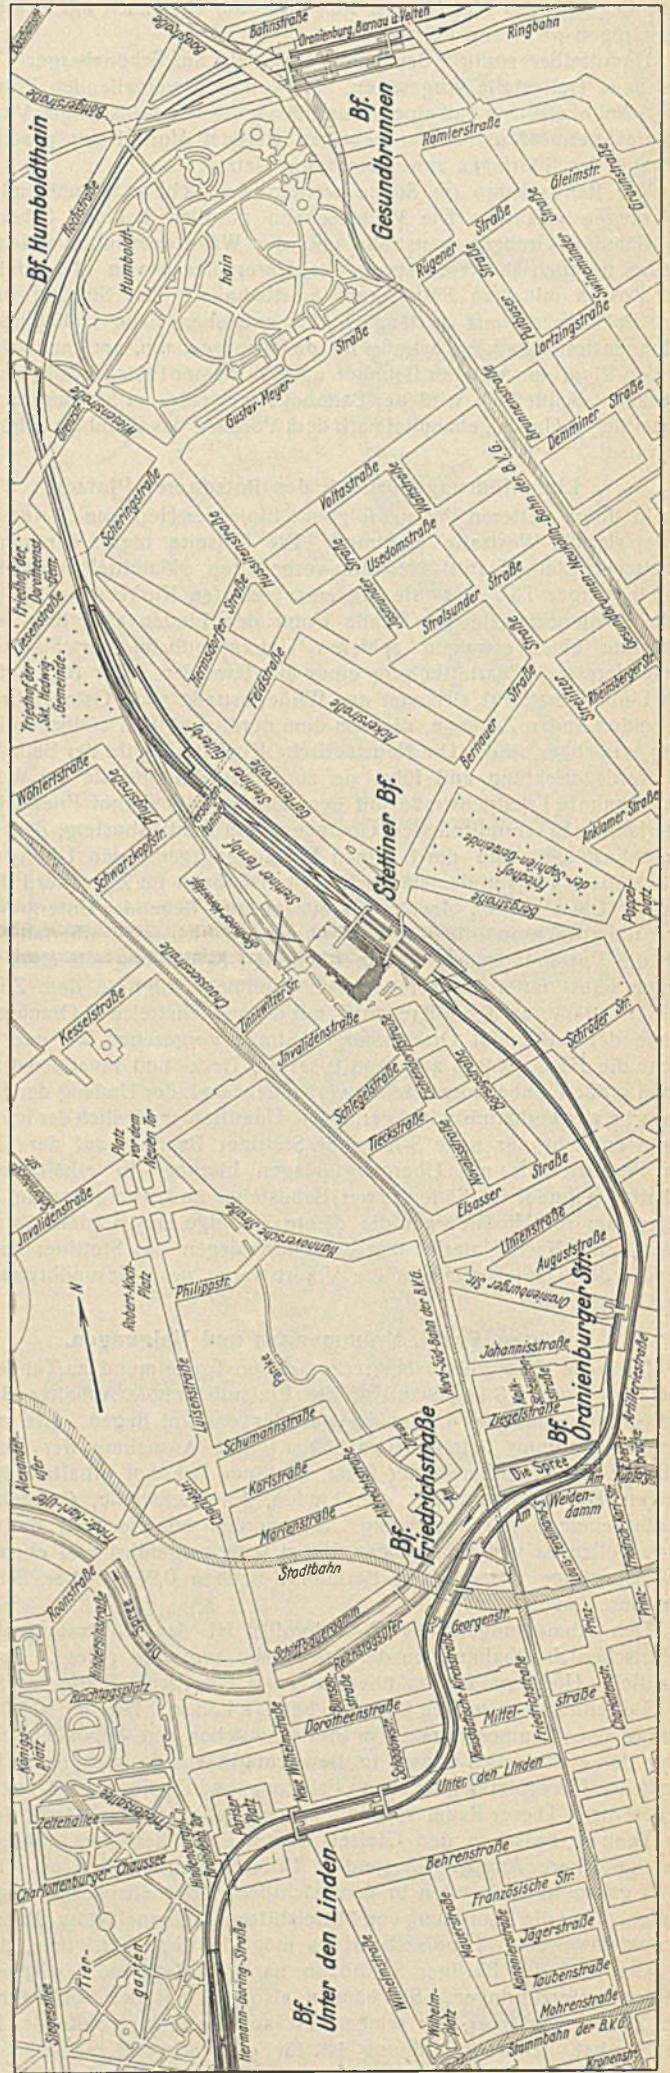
Lageplan Abschnitt Lennéstraße—Bahnhof Gesundbrunnen.
